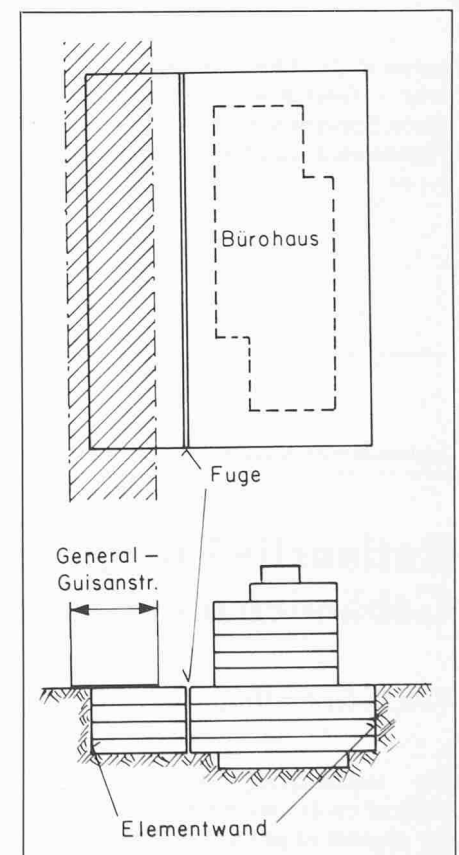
Schematischer Schnitt und Grundriss des Neubaus der «Winterthur-Versicherungen»
